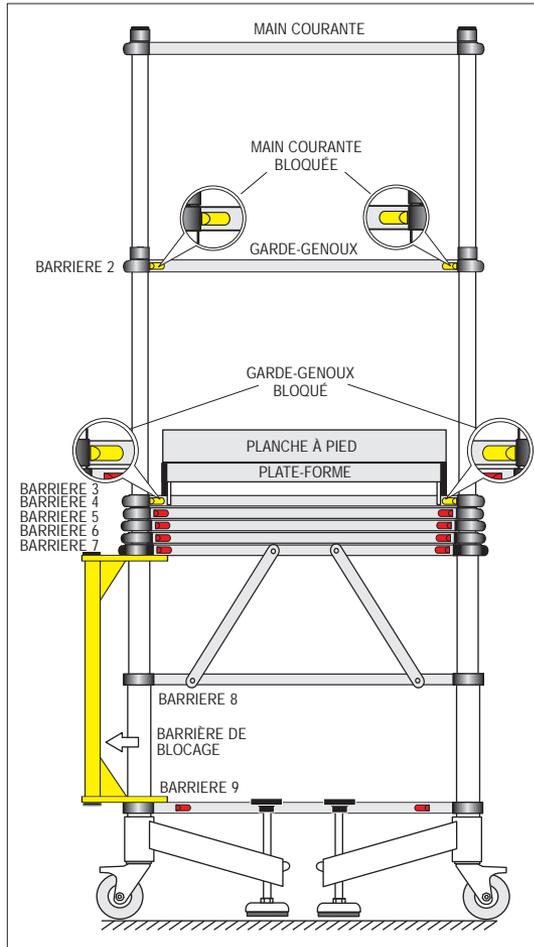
,25 MÈTRE DE HAUTEUR
